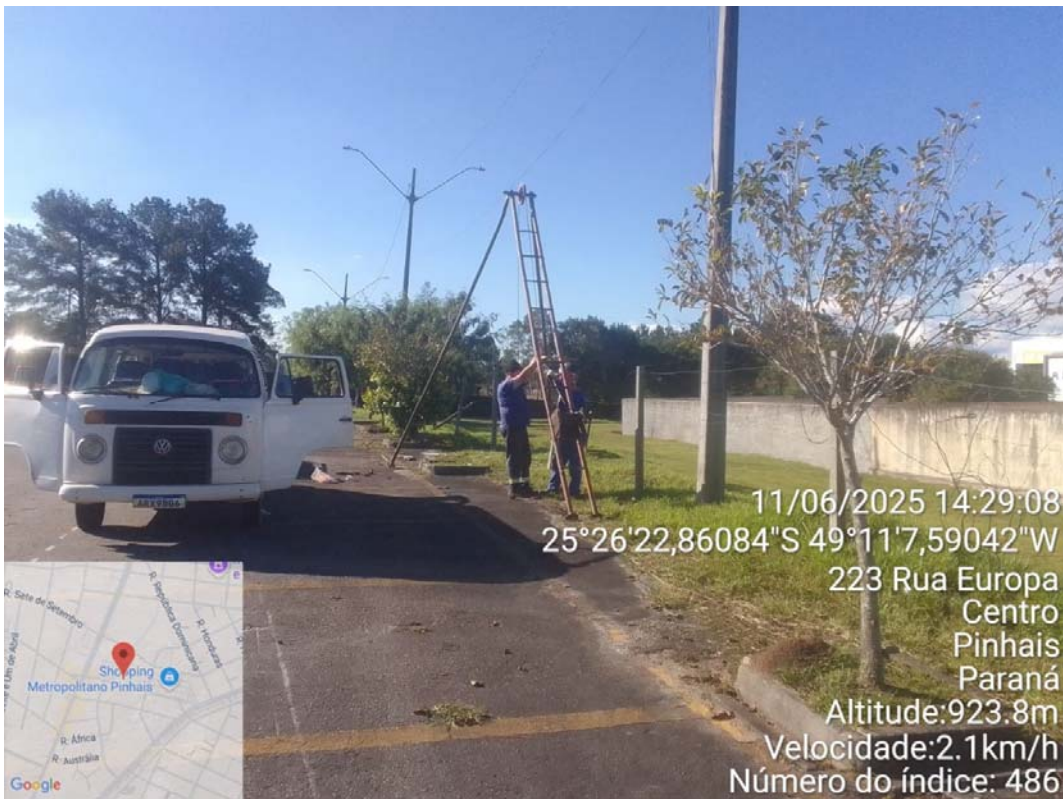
Perfuração do furo SP-01. Foto Alexandre.
